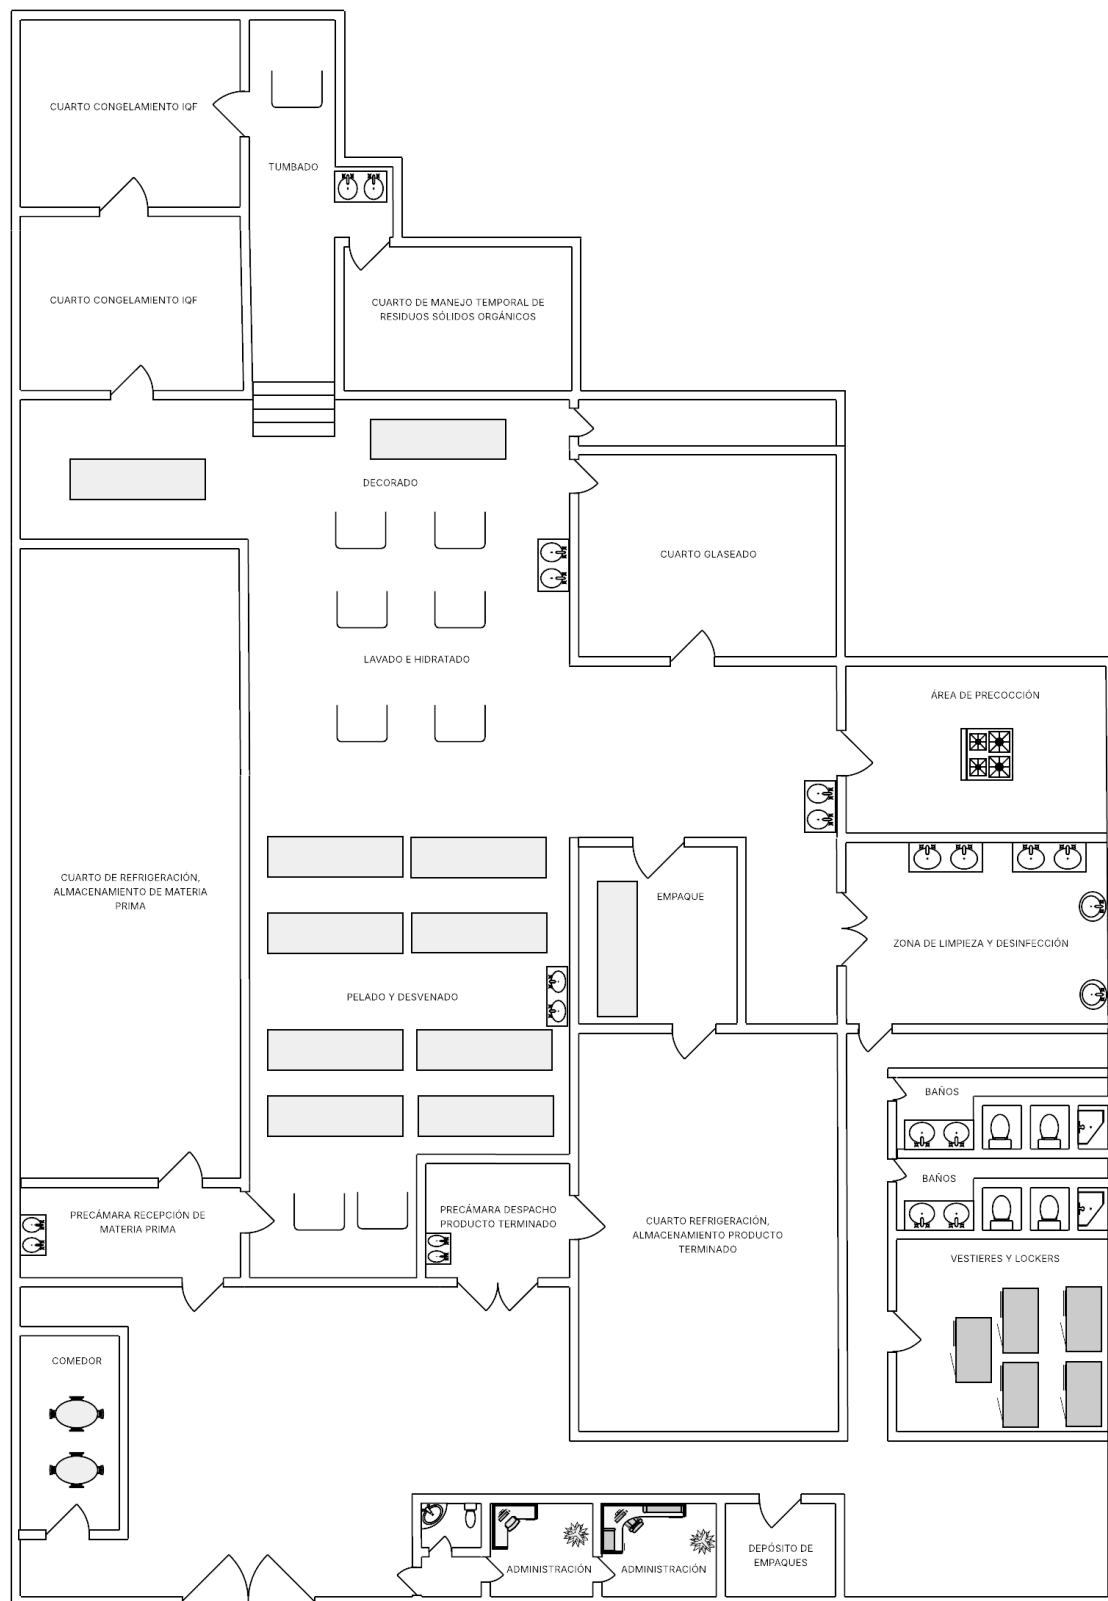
Propuesta de distribución de planta para la empresa caso de estudio. Fuente: elaboración propia
